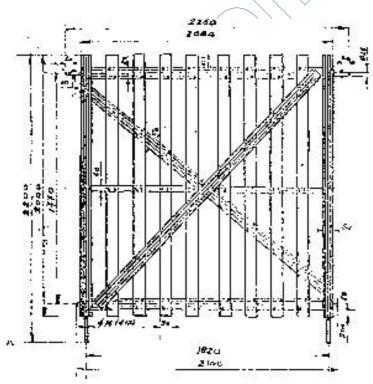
Panou mobil de parazăpezi din metal pe cadru din oțel rotund
